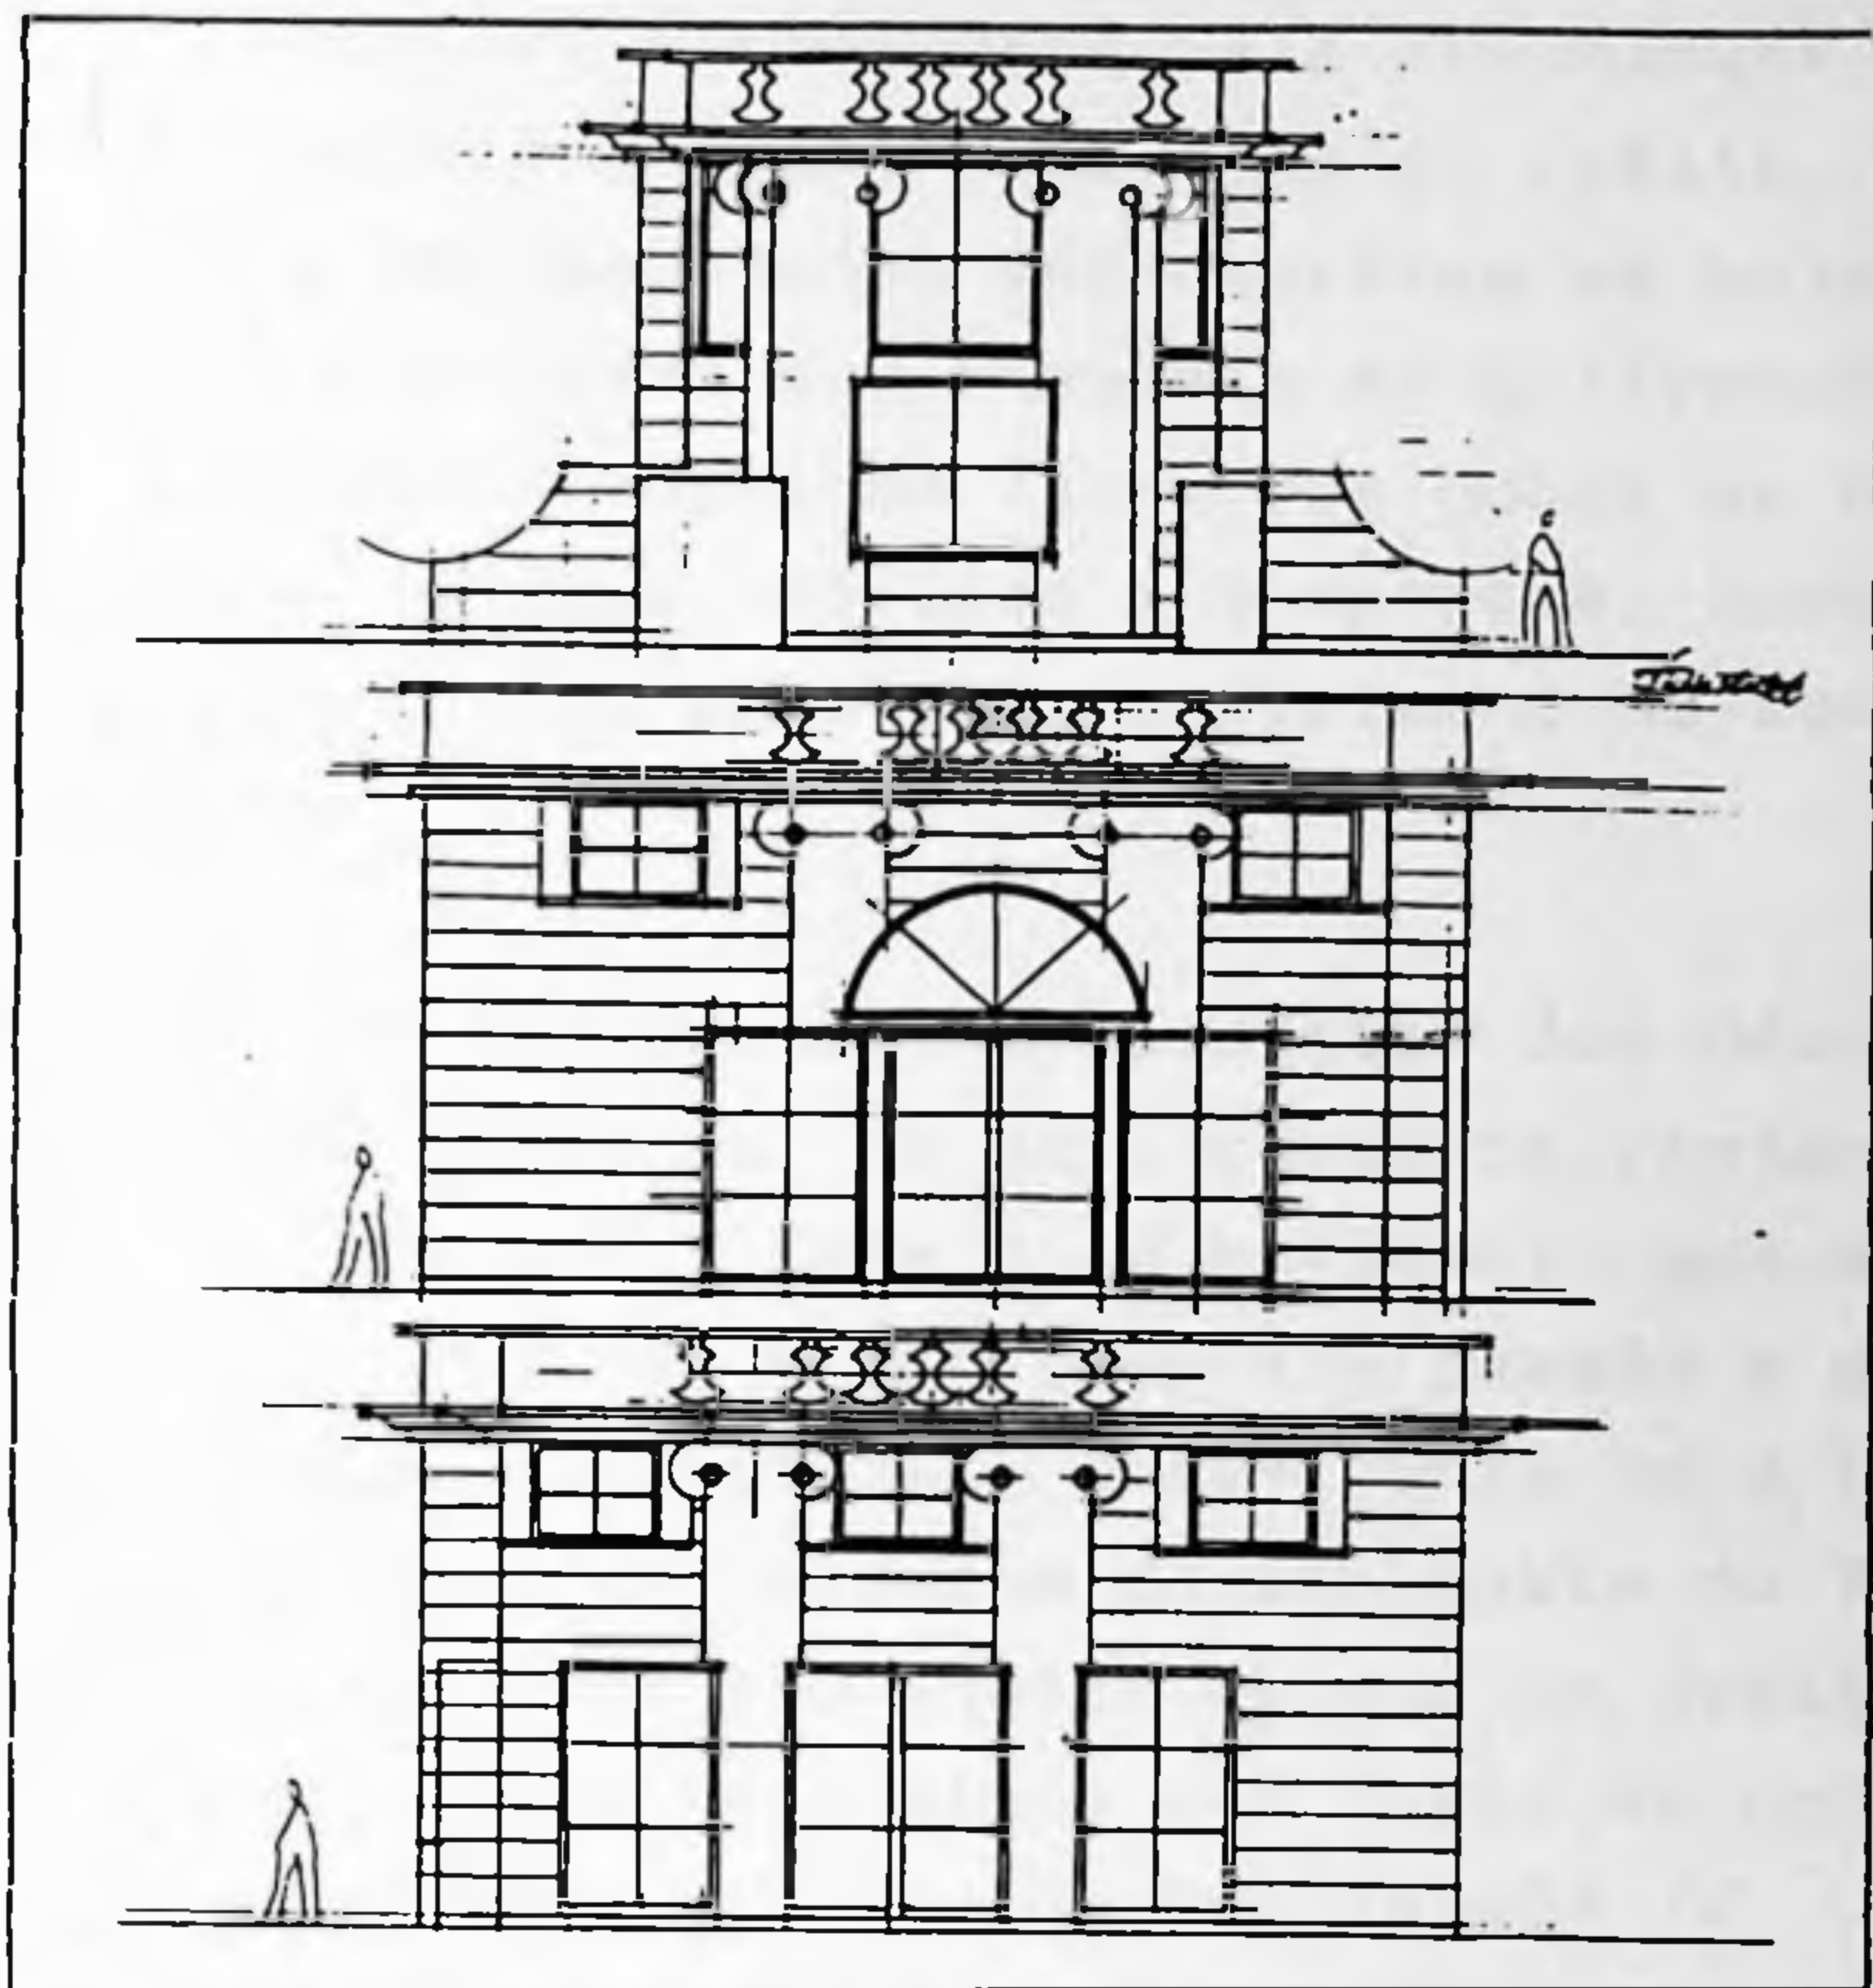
Robert Venturi e John Rauch, 1977. Fachada de casa em New Jersey.
